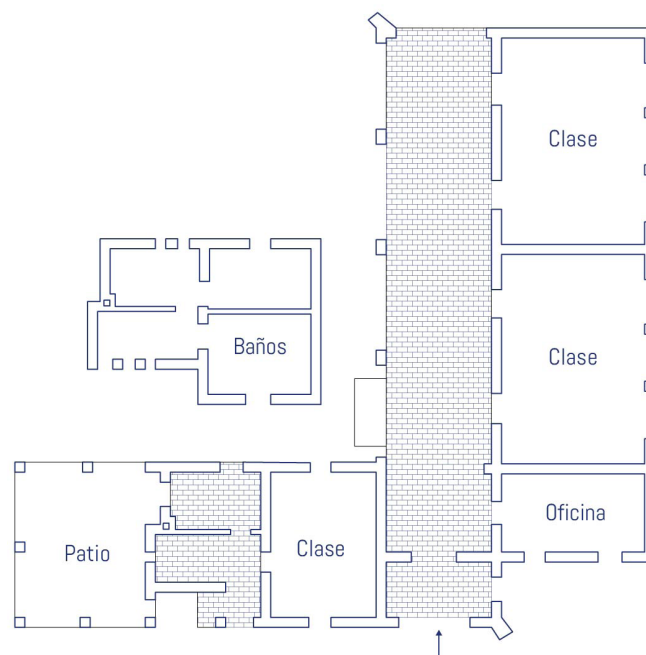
Planta Tipo de Escuela Rural para 80 alumnos en la zona central. Elaboración Propia a partir de: Archivo Fotográfico, Dirección de Arquitectura del Ministerio de Obras Públicas.
